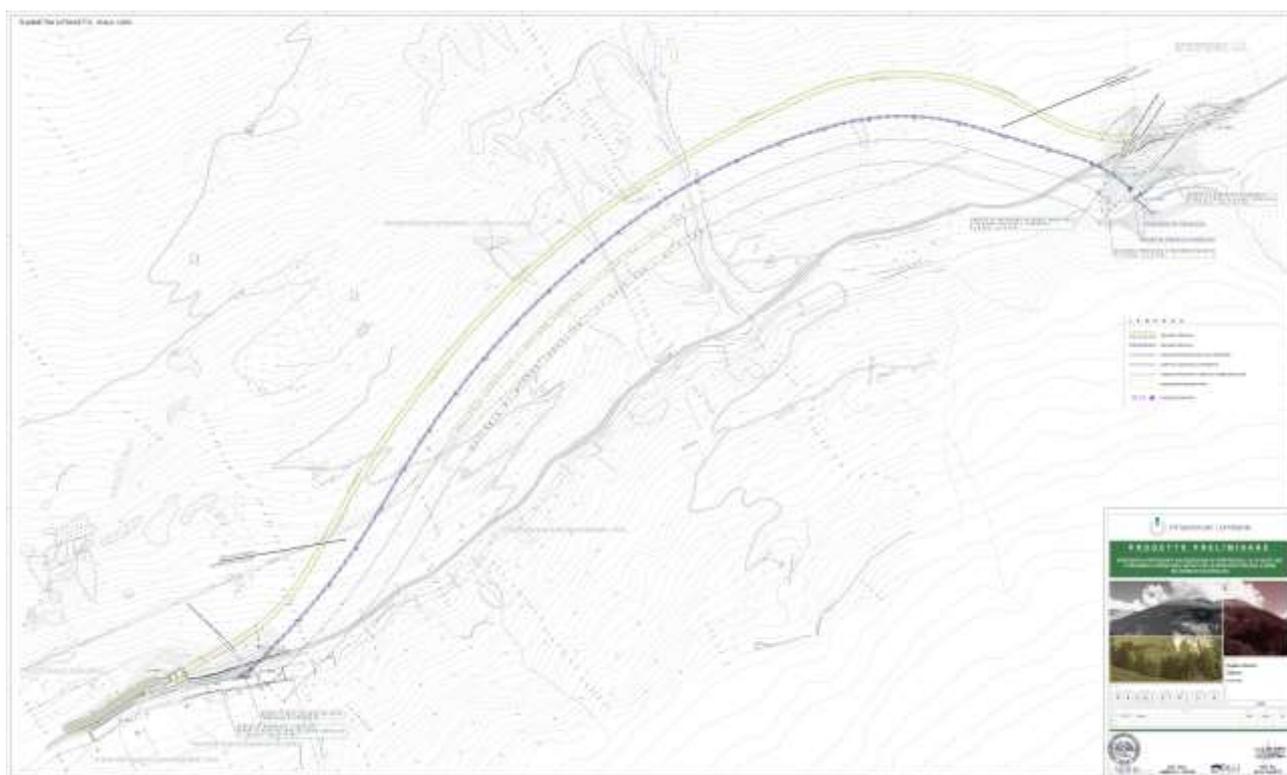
By-pass stradale – Galleria – Planimetria (progetto preliminare 2013: elaborato P-A-GAL-ST-PL-01-A)
